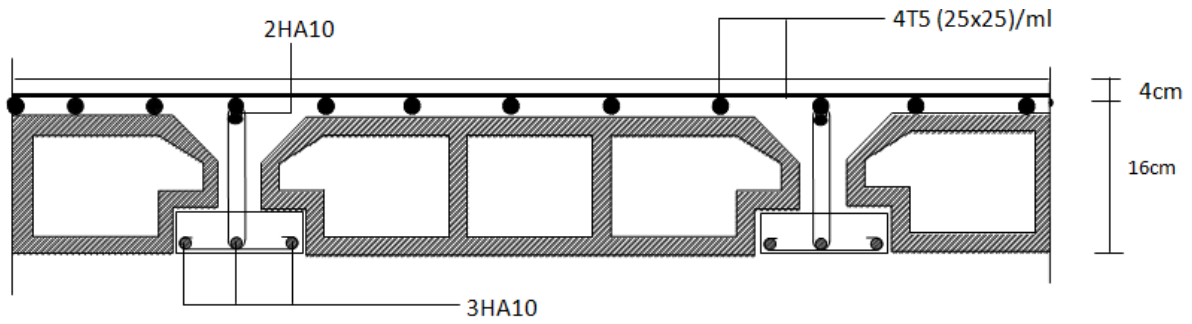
ferrailage de poutrelle en travée
